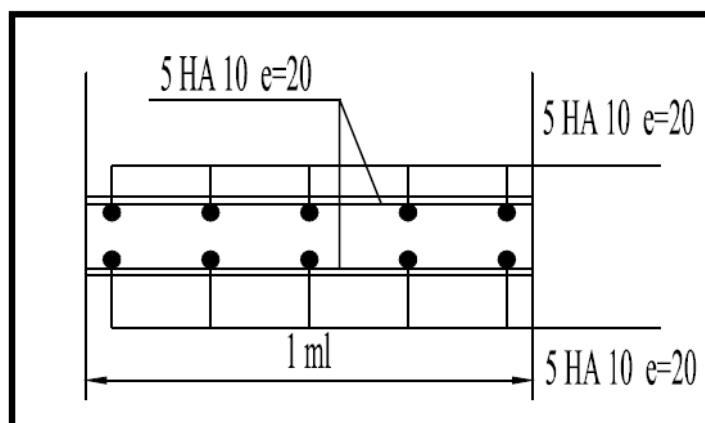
Schéma de ferrailage de la dalle La dalle de l'ascenseur.
